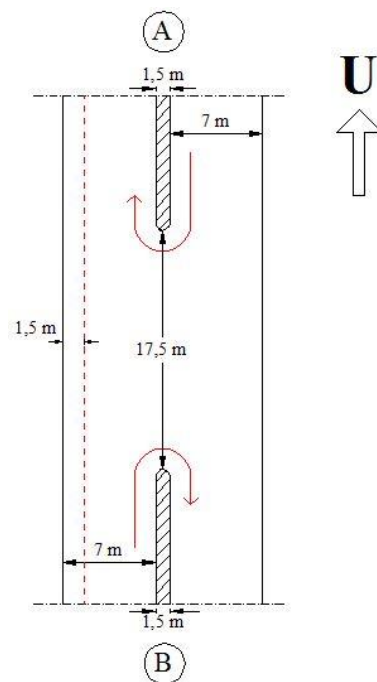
Potongan Tampak Atas Geometri Ruas Jalan Affandi (Segmen 5 dan 6)
